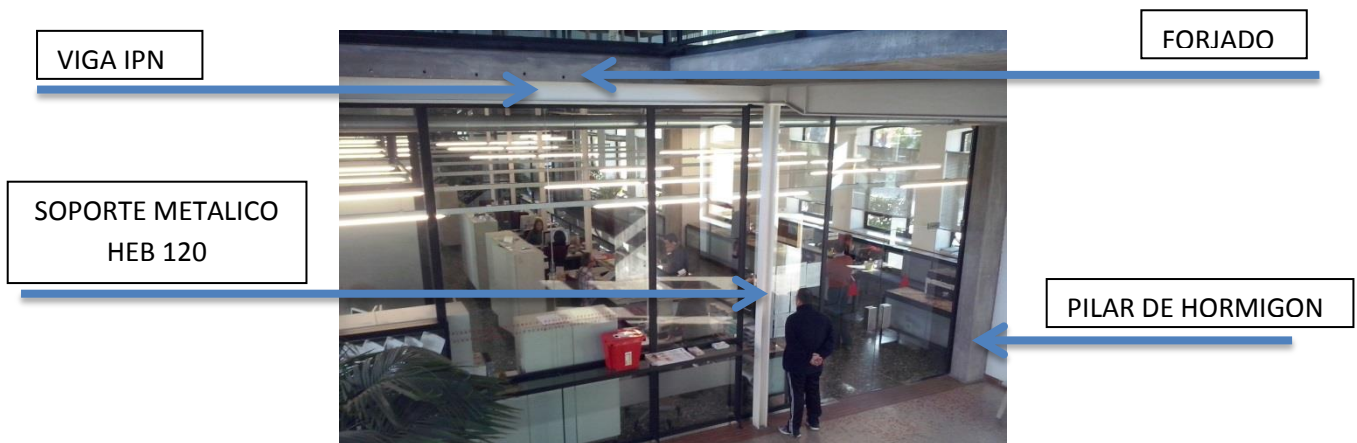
MEMORIA CONSTRUCTIVA: Estructura. Fuente: Propia
